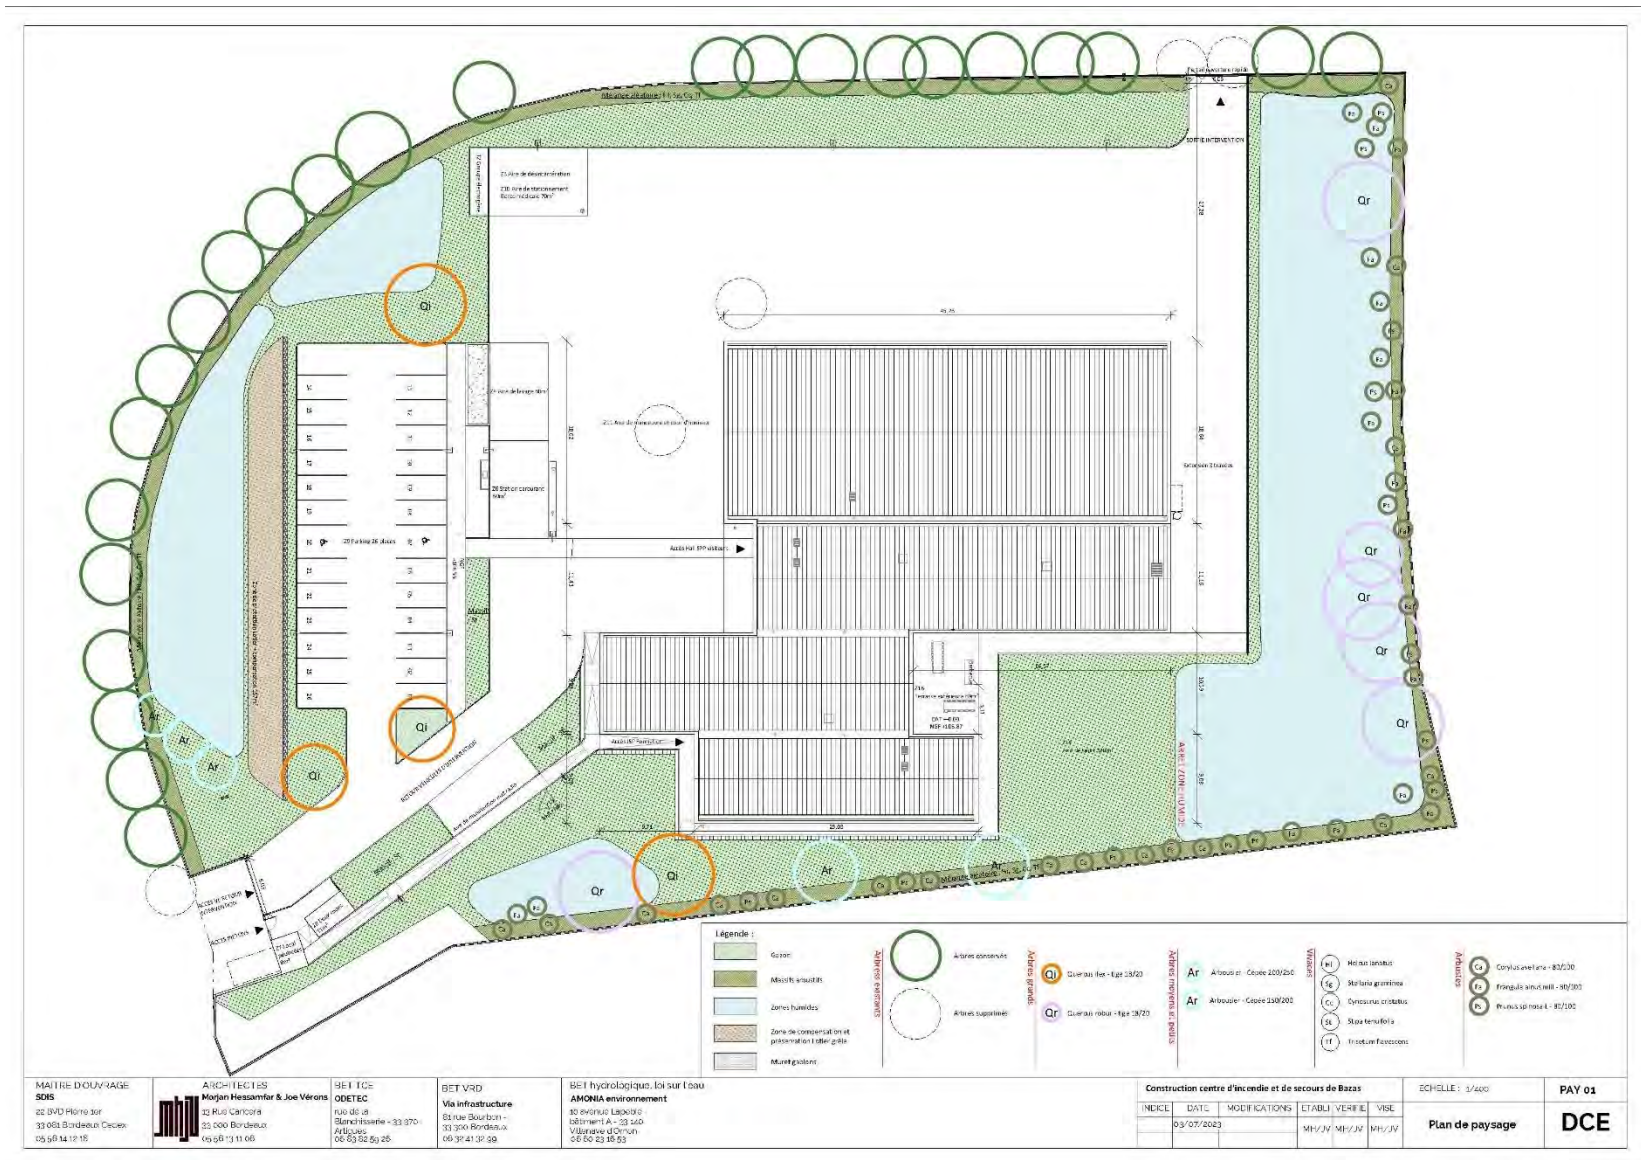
Plan de plantation (Hessamfar & Verrons, 16/06/2023)
